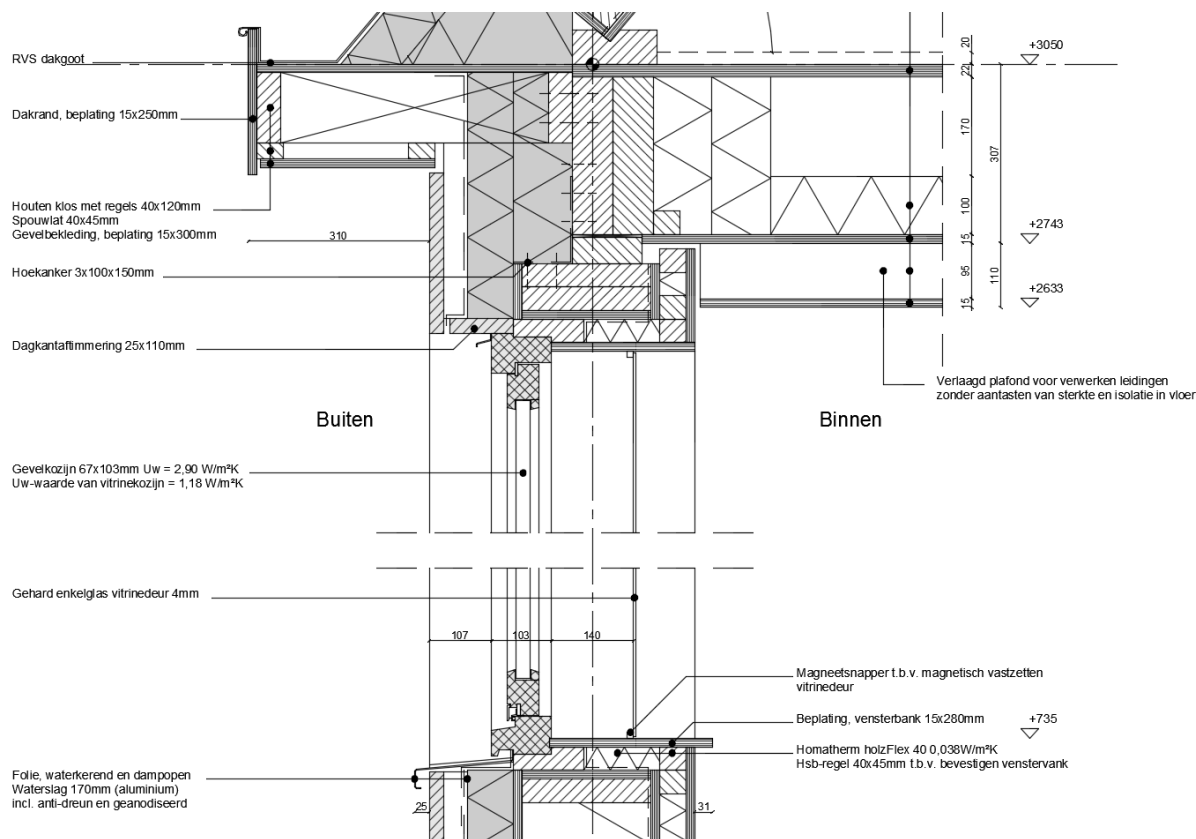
Fragment detailblad 3, binnenbladrenovatie Achterdonk 60, kozijnaansluiting
